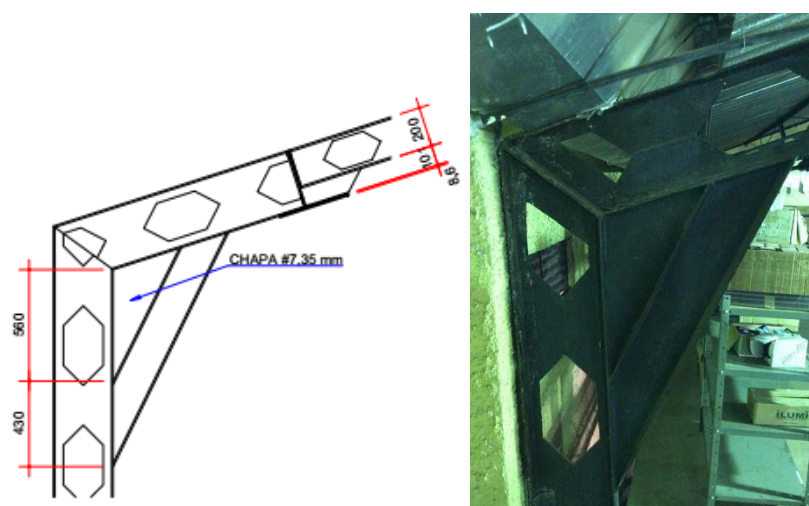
SEÇÃO TÍPICA DA VISTA DA TESOURA DA EXTREMIDADE (DIMENSÕES EM MM)
